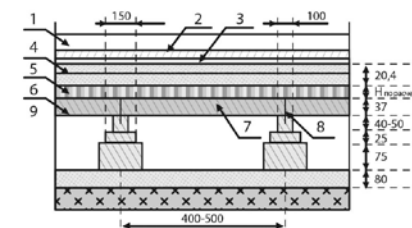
Укладка напольного покрытия на старом дощатом полу: использование ГВЛ или фанеры
